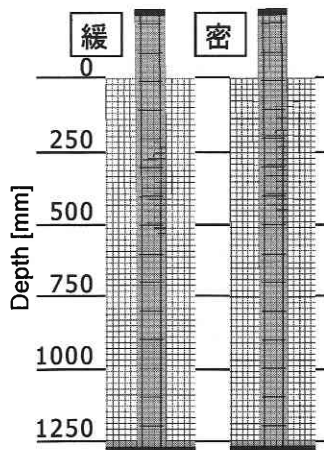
ひび割れ図 (杭頭変位 5 mm 時)
